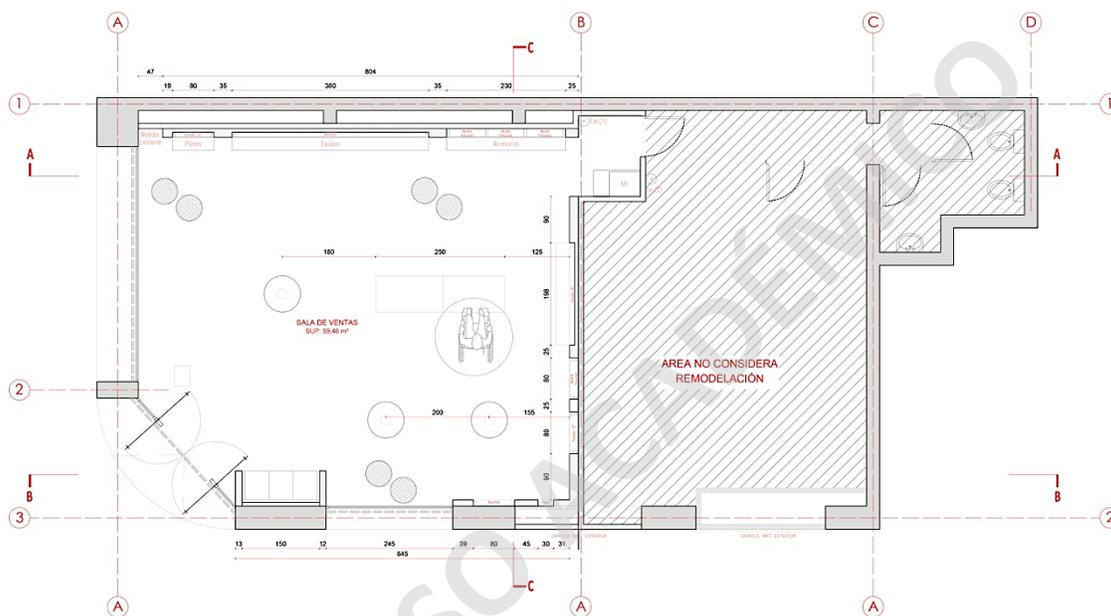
Sucursal Viña Echevers – Planta Arquitectura.
